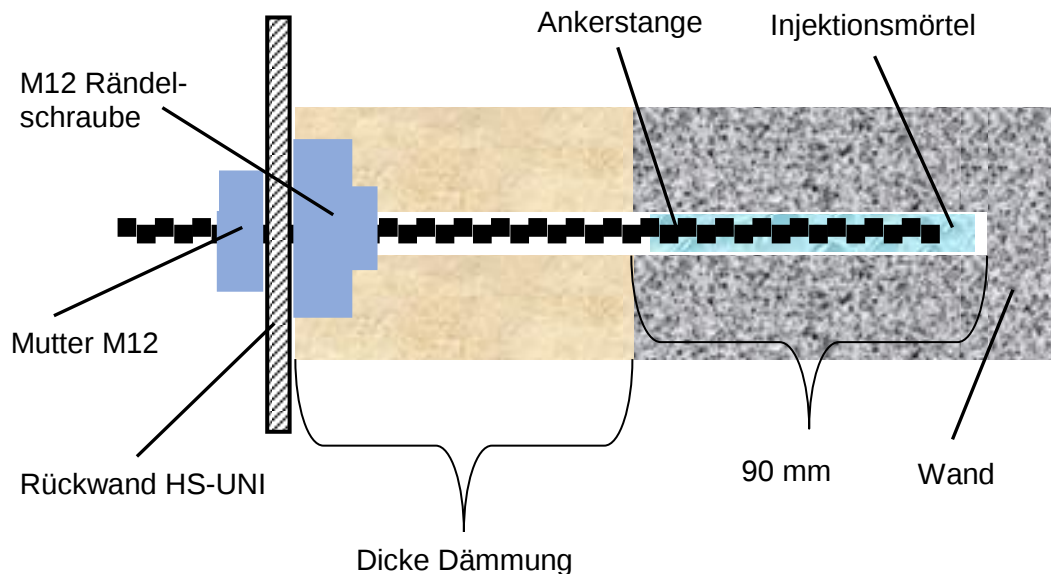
Wandmontage gedämmte Fassade mit Rändelschraube
